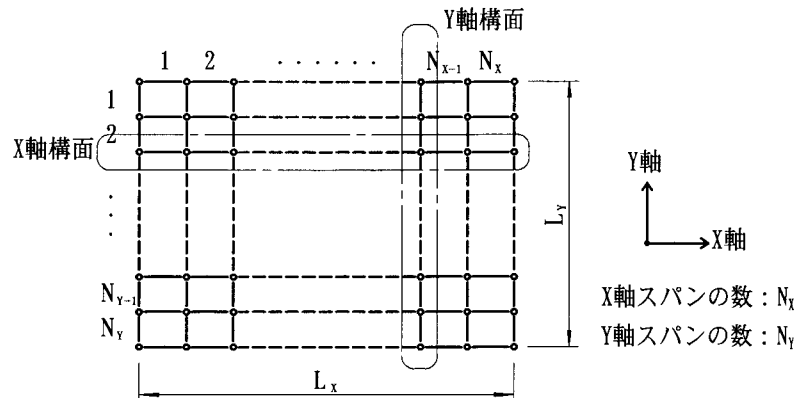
立体モデルから取出される平面モデル（平面図）
